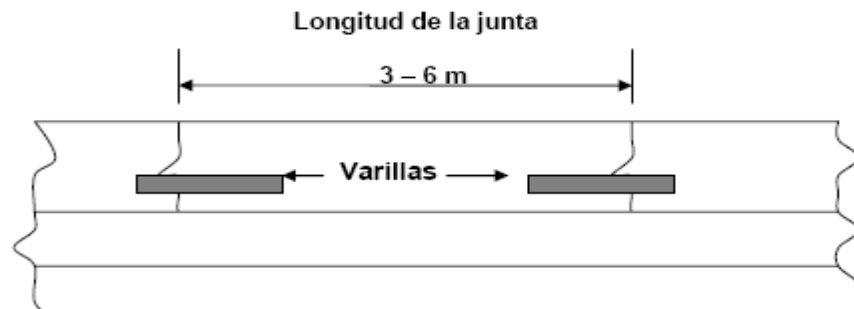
Pavimento de concreto simple con dovelas (JPCP)
